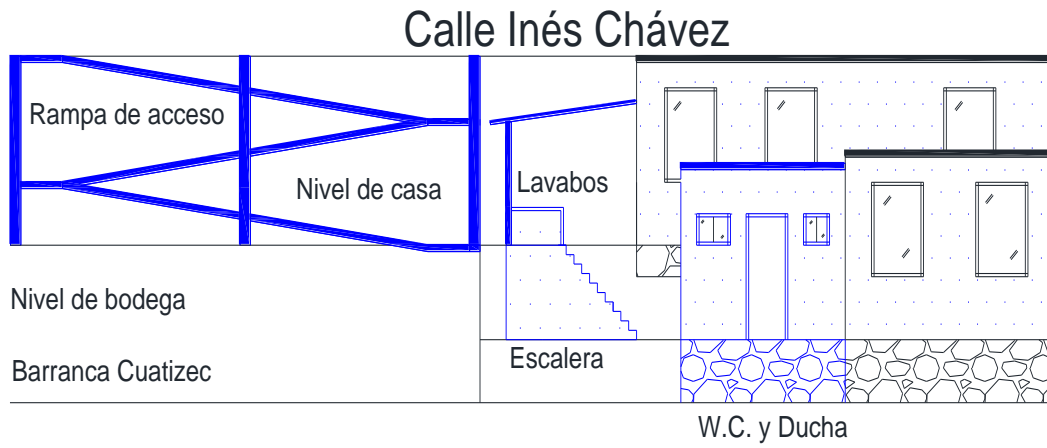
Facha principal de recomendación con color azul en vivienda de la barranca Cuatizec.
